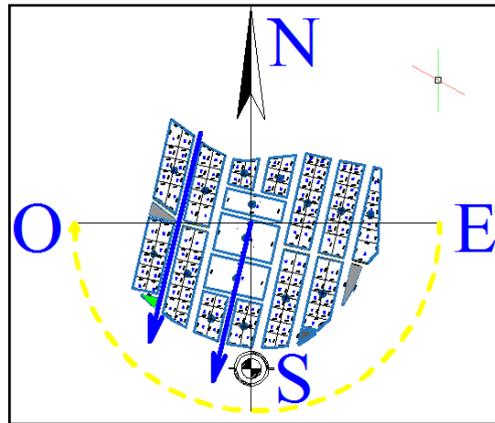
Asoleamiento zona 2 Condor Pasa.
